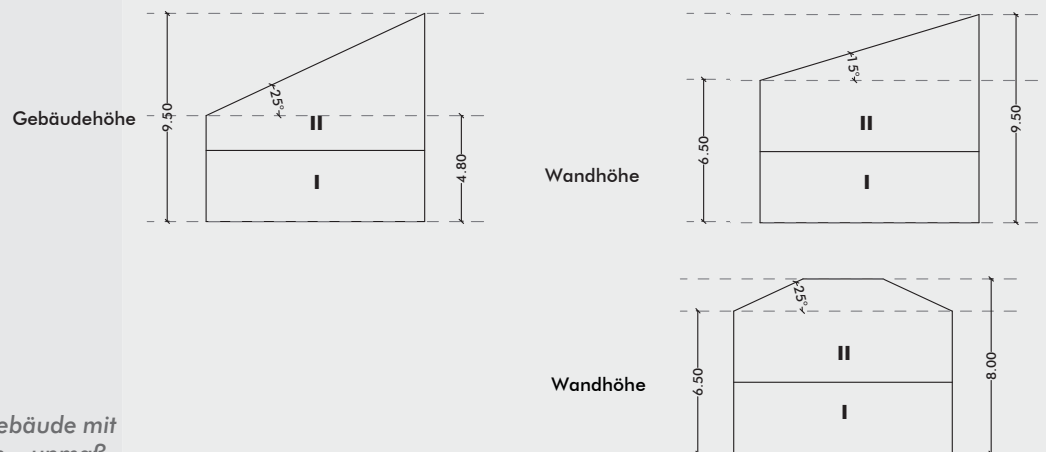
Schemaschnitt Gebäude mit Pultdach und Walmdach, unmaßstäblich
